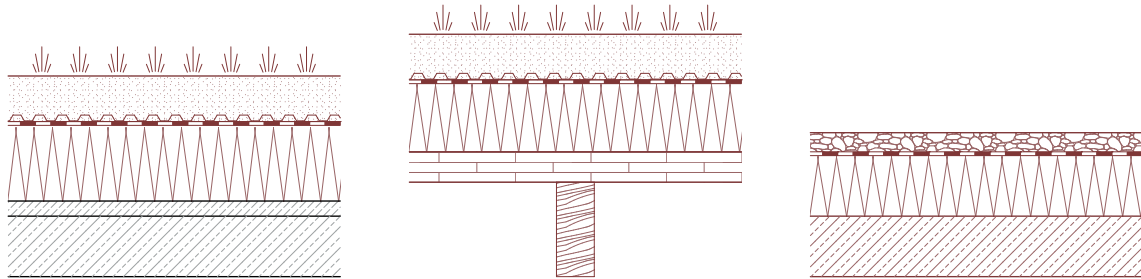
Details Geschossdecke, M 1:20, eigene Darstellung
